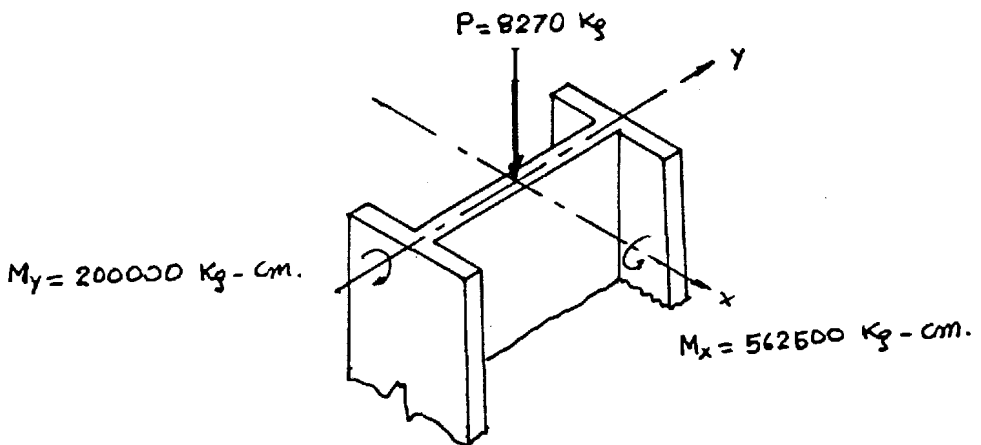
CARGA AXIAL SOBRE COLUMNA
